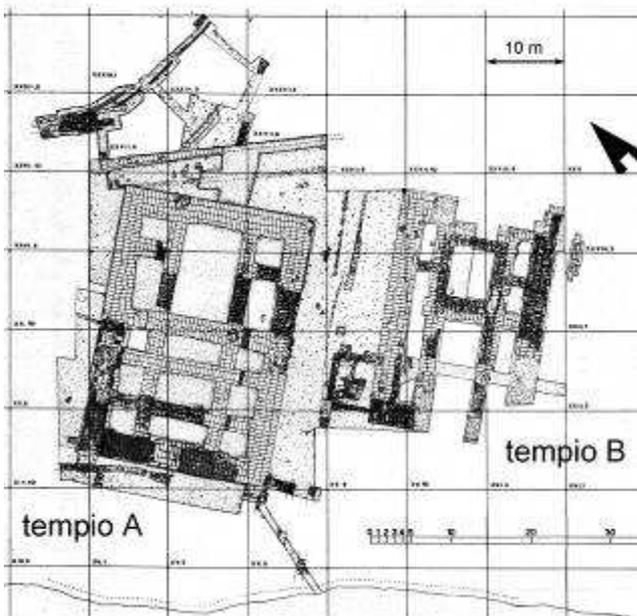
Pyrgi. Planimetria dei resti del Santuario (COLONNA 1970, rielab. dell'autore)
